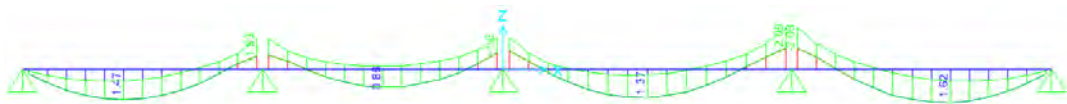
Envolvente de DMF de vigueta tipo I (ton-m)
